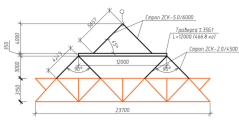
Графическое определение длины стрелы для монтажа стропильной фермы
